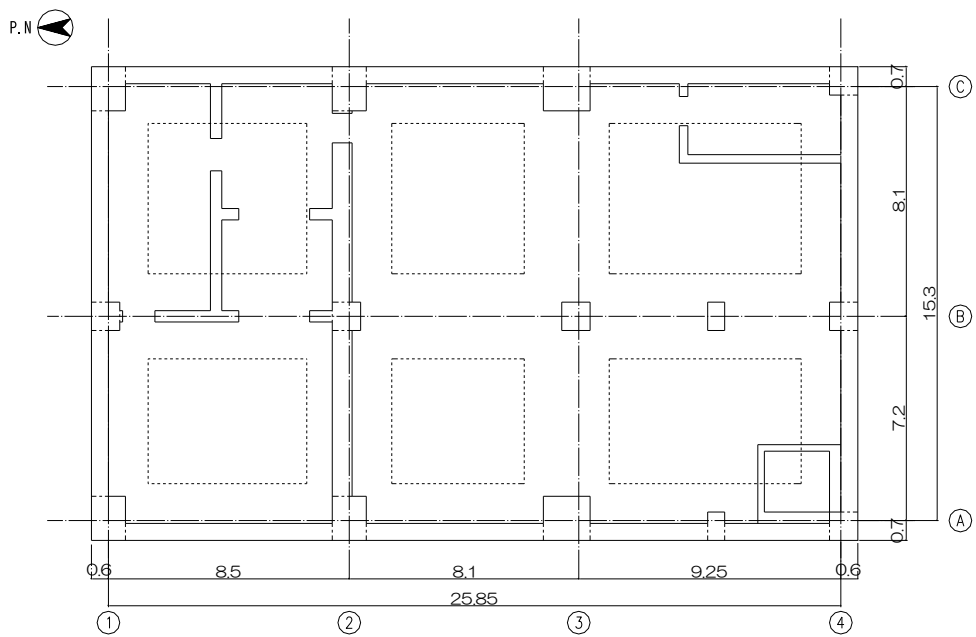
地下1階平面図 (G.L. -6.75) (単位 : m)
